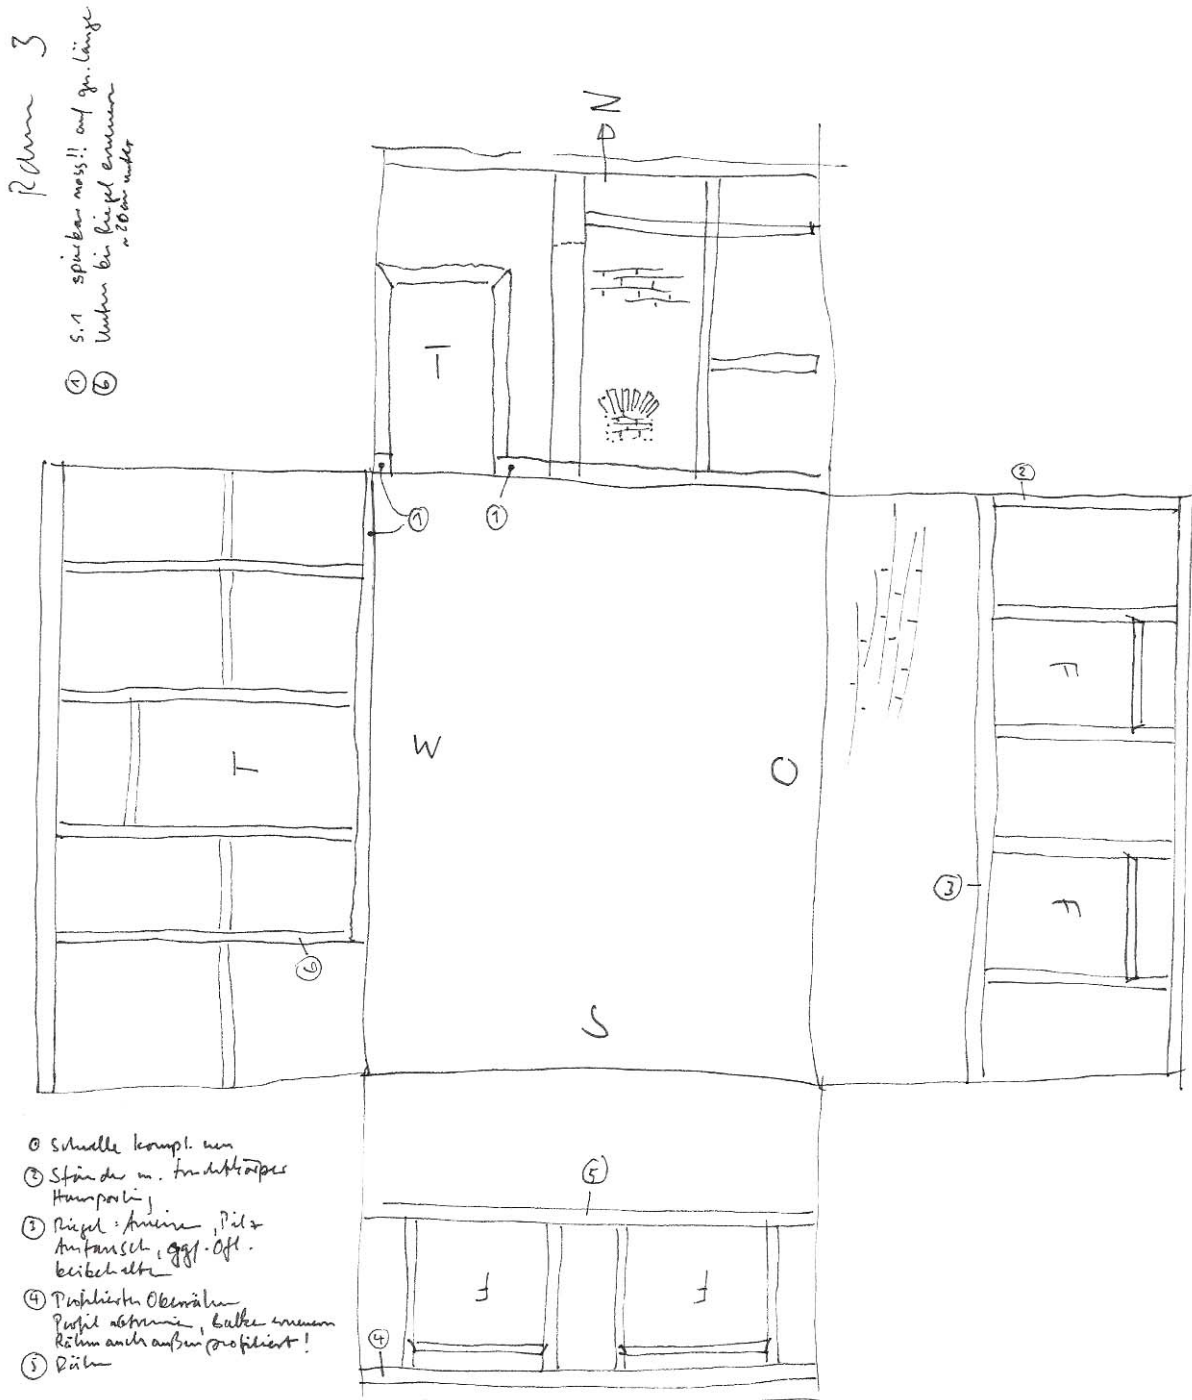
Raum 3, Grundriss und Wandflächen
